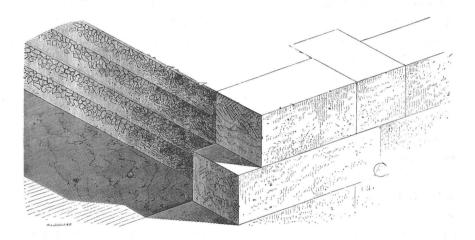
Muro romano con núcleo de hormigón apisonado y paramentos de sillería
